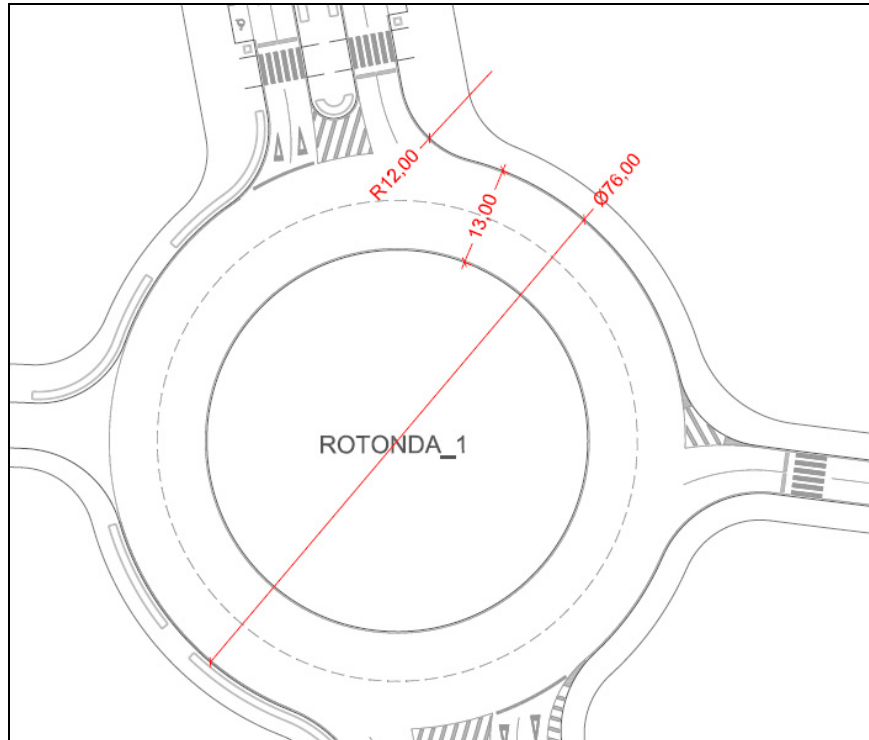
Planta de la rotonda 1 (Sur) de la vía estructurante de Tamaraceite
